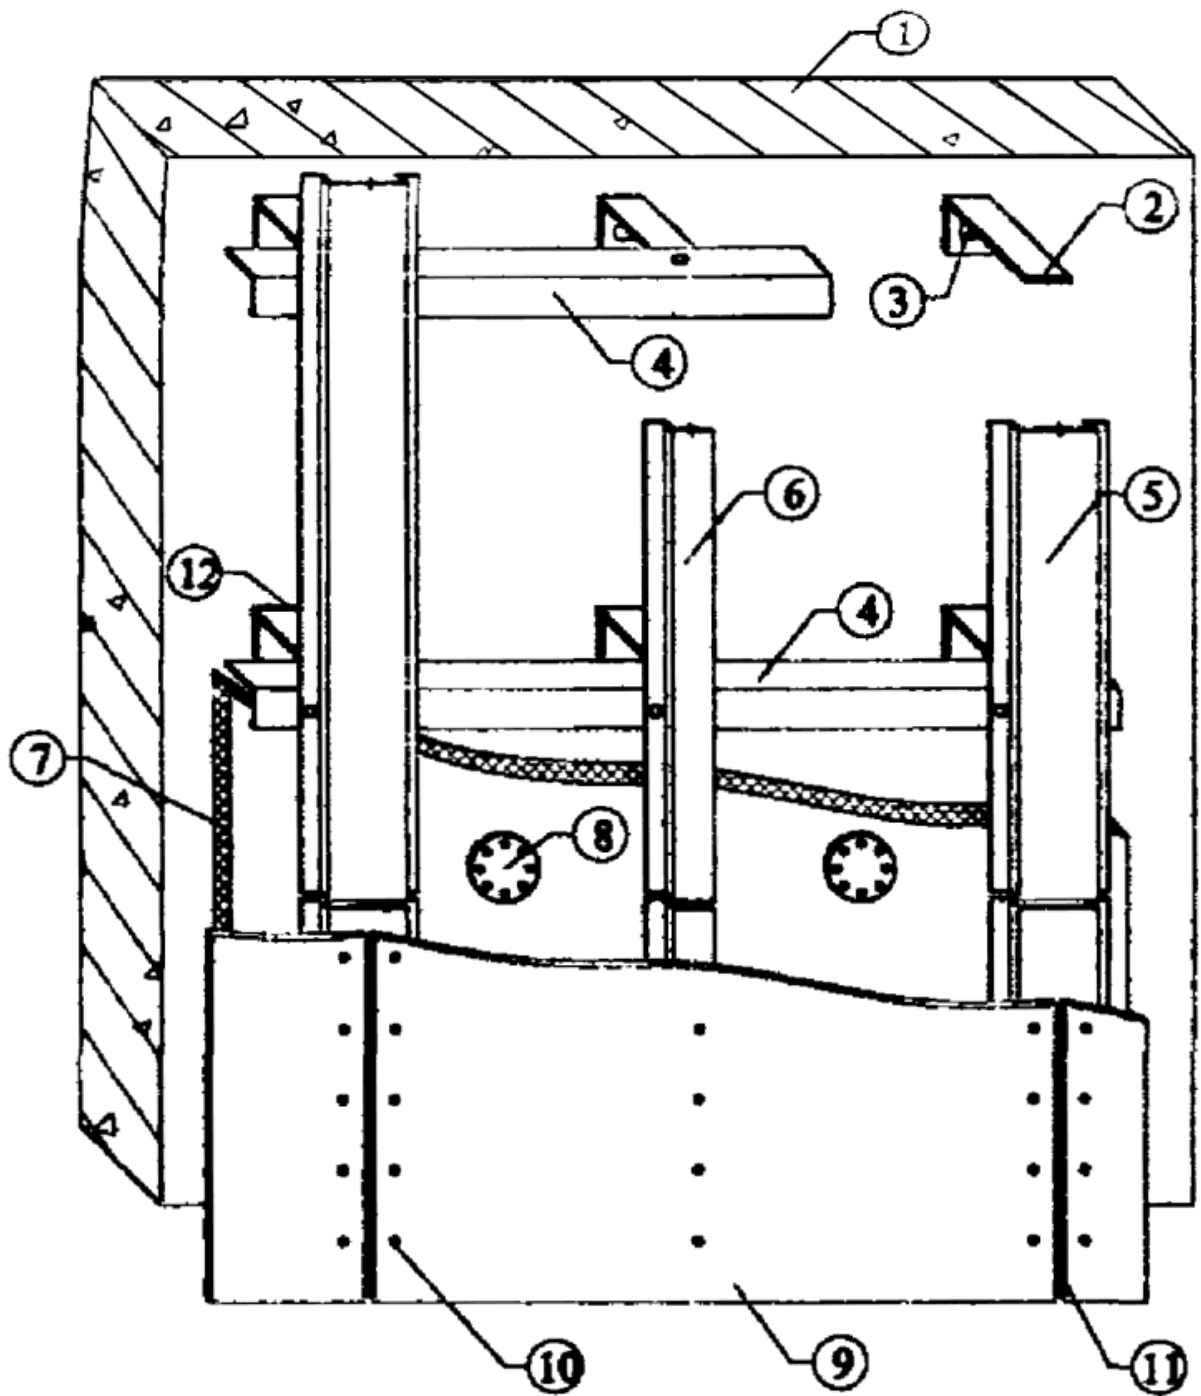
Фрагмент конструктивного решения фасадной системы "Краспан"
